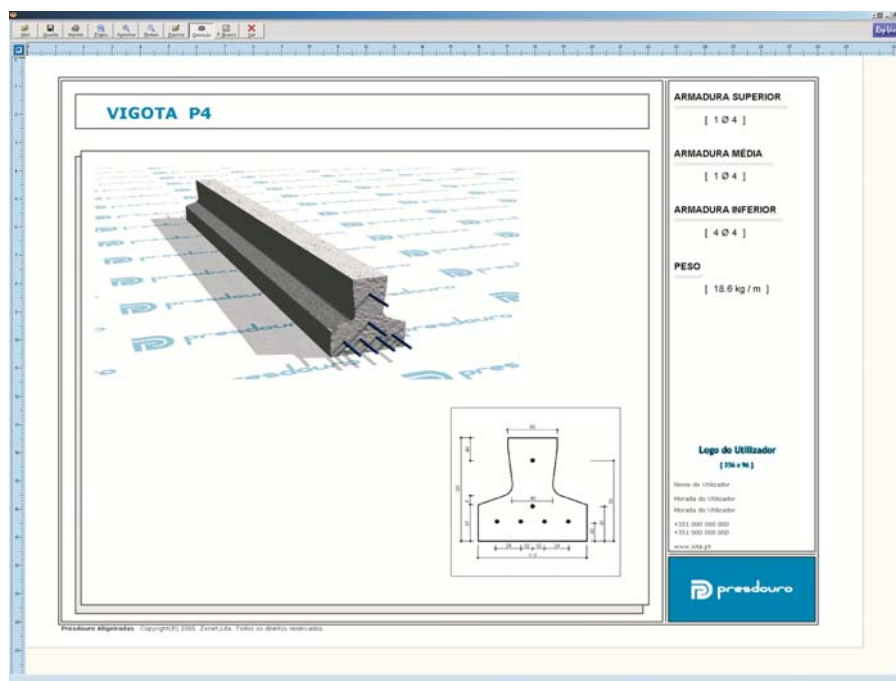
Reporte de Laje escolhida da Lista de Vigotas
